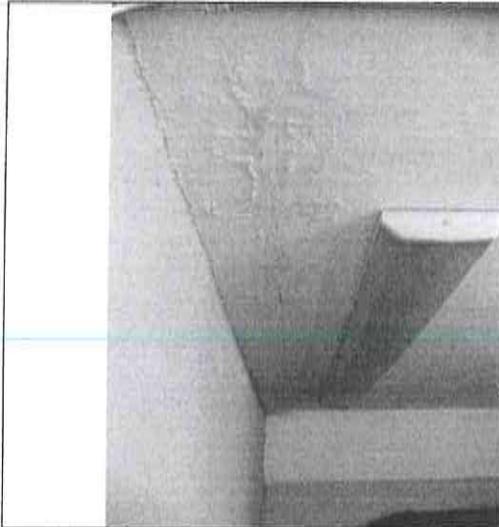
Fisuras en lecho bajo de la losa de techumbre.
